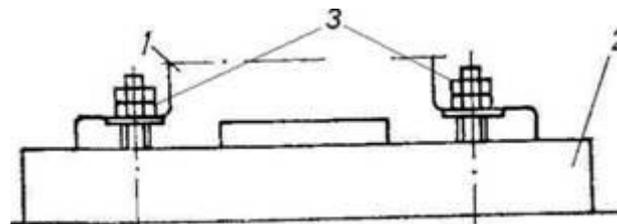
Схема установки оборудования на фундамент с опиранием непосредственно на фундамент:
